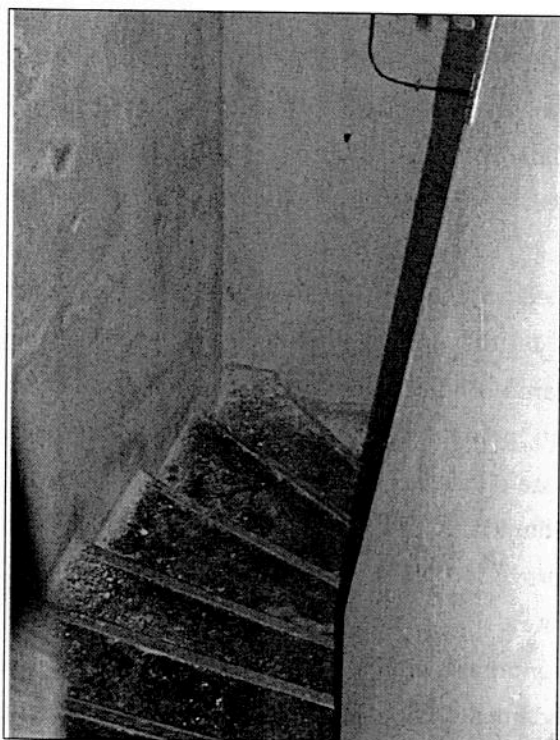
scale da pianerottolo nel piano S2 bene C, verso bene piano S3 bene B5
